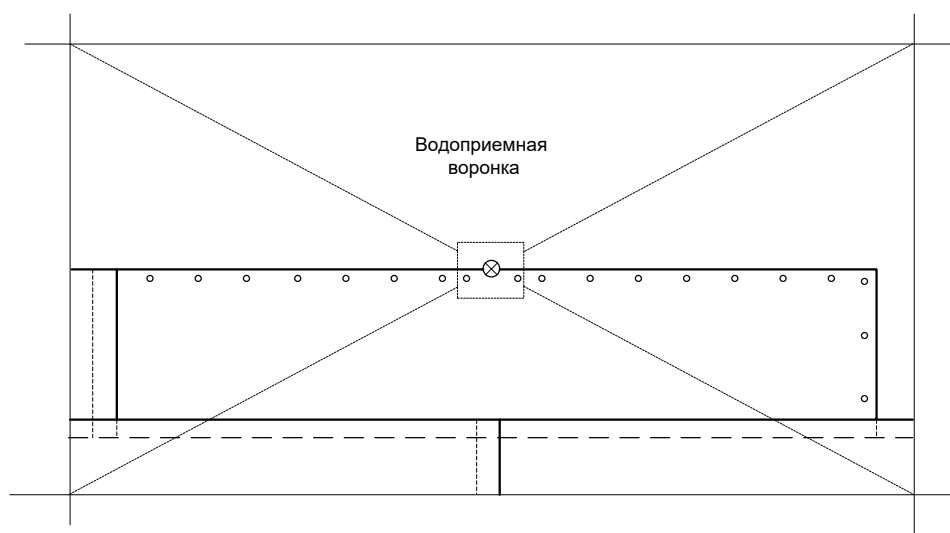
Схема укладки первого полотна нижнего слоя кровельного ковра у водоприемной воронки
